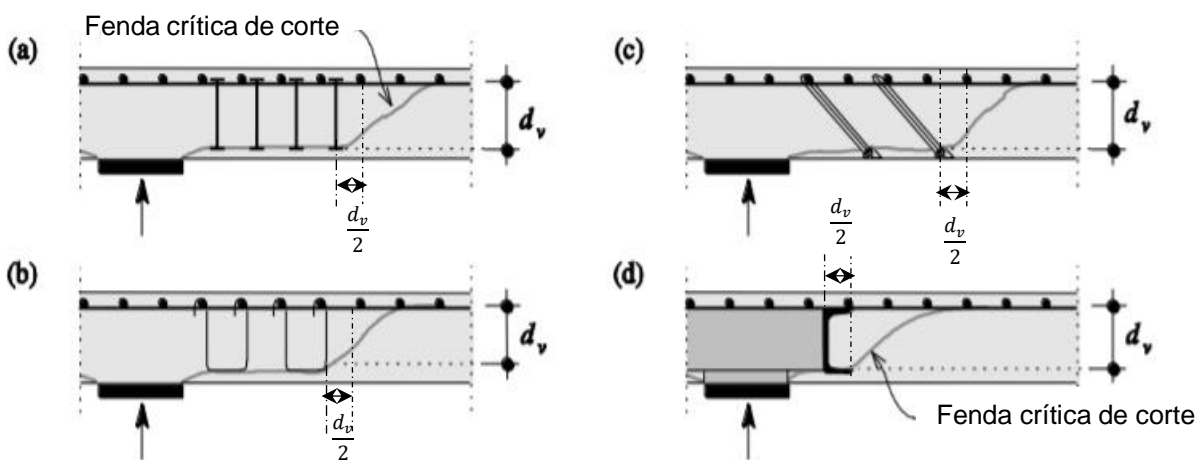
Perímetro de controlo fora da zona reforçada com armadura transversal e altura efectiva da laje: (a) Parafusos; (b) Estribos; (c) Armadura oblíqua com placas de ancoragem aderentes; (d) Perfis de aço (adaptado [24])
